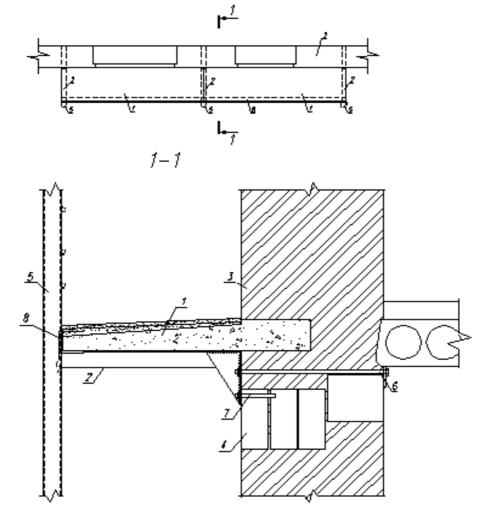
Усиление вертикального ряда смежных балконов с помощью стоек: 1 - балконная плита; 2 – металлическая балка из прокатного уголка; 3 – стена здания; 4 – железобетонная перемычка; 5 – стойка; 6 – сквозной анкер; 7 – глухой анкер; 8 – металлическая балка из прокатного уголка
